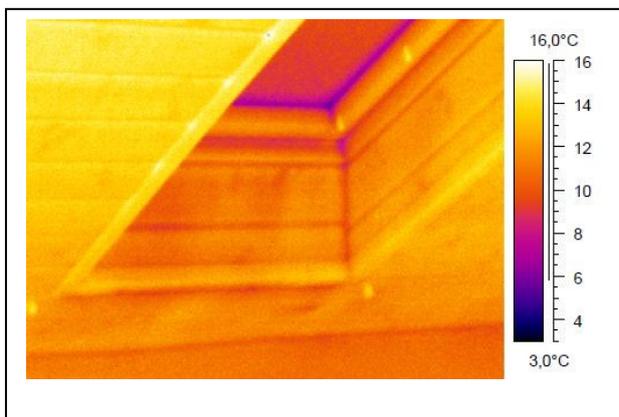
Dachflächenfenster vor Blower Door (Luftdichtigkeitsprüfung)
